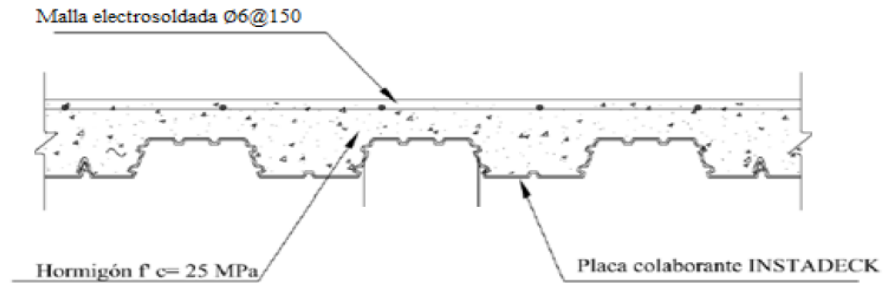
Sección transversal de la losa colaborante (Fuentealba,2017)
